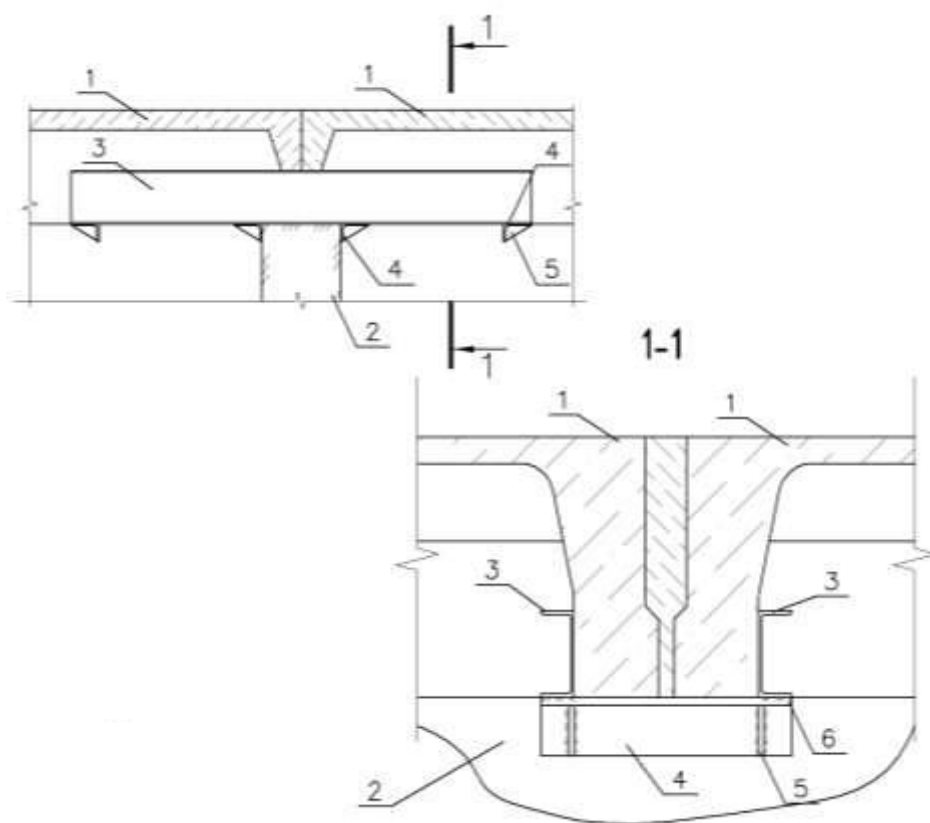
Установка консольных балок из швеллеров с опорными столиками
